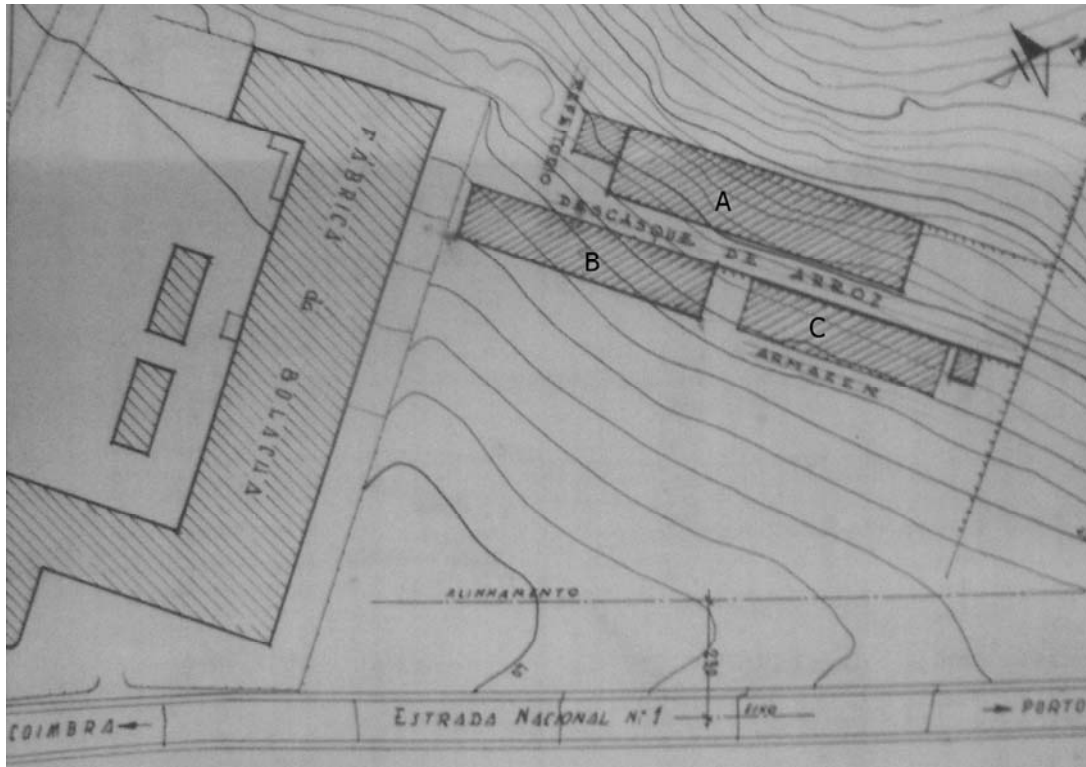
| Planta de localização dos armazéns de descasque de arroz
